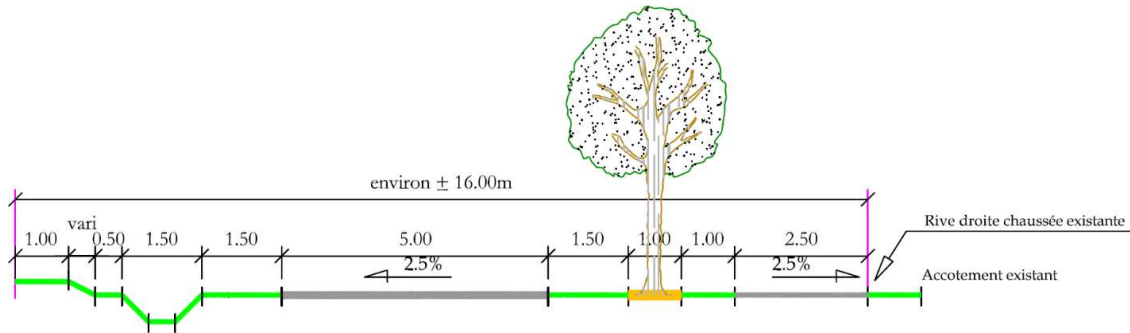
Profil en travers de la chaussée décalée (à gauche) et de la piste (à droite)
